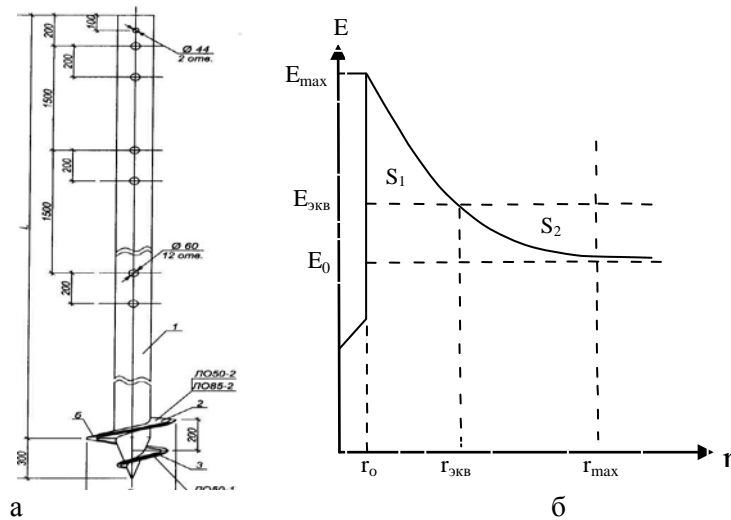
а) конструкция винтовой металлической сваи;
